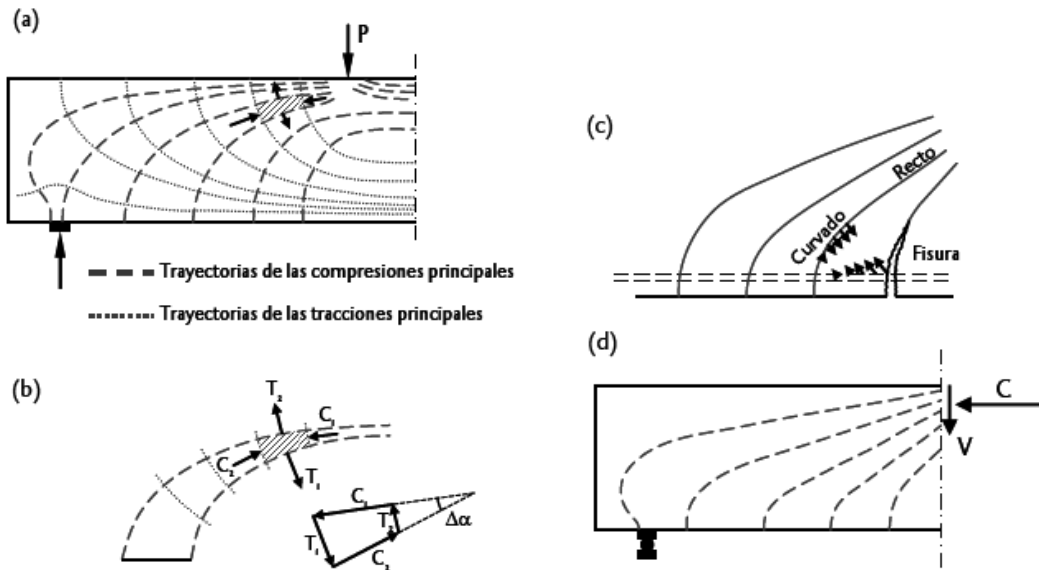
b. Desarrollo de las líneas de tensiones en una viga de hormigón armado según Kani (P. Padilla)
